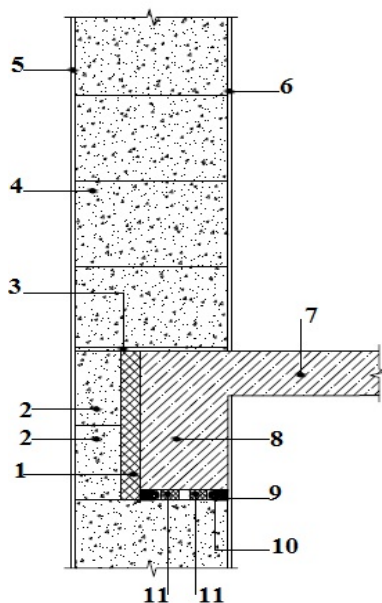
Стена из газобетонных блоков на монолитном железобетонном ригеле в составе перекрытия (каркасно-монолитное строительство): 1 — вкладыш из эффективного утеплителя; 2 — доборные блоки; 3 — выравнивающий раствор; 4 — блоки YTONG; 5 — наружная отделка; 6 — внутренняя отделка; 7 — монолитное железобетонное перекрытие; 8 — железобетонный ригель; 9 — герметизирующая нетвердеющая мастика; 10 — поризол (гернит); 11 — минеральная вата
